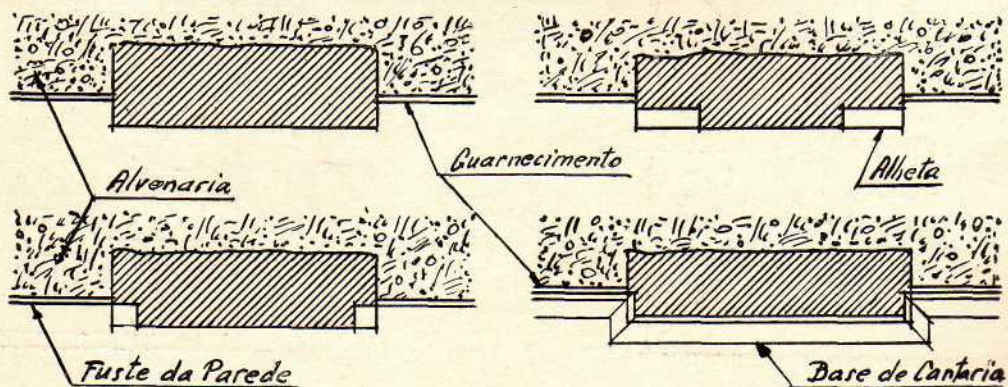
PLANTAS DAS DIVERSAS PILASTRAS
